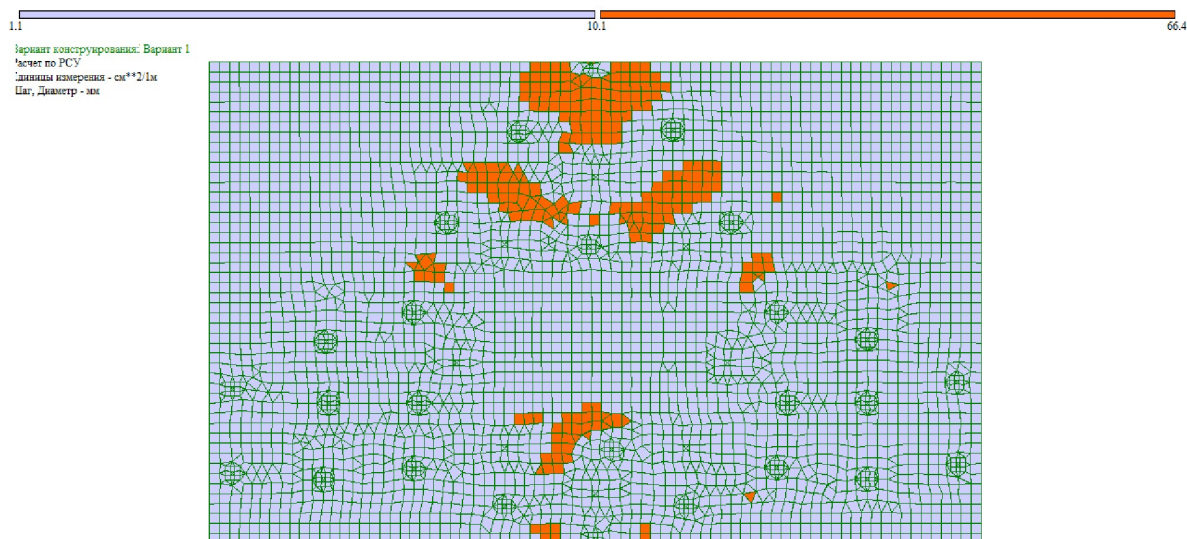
Армування фундаментної плити (Верхня по Y)
